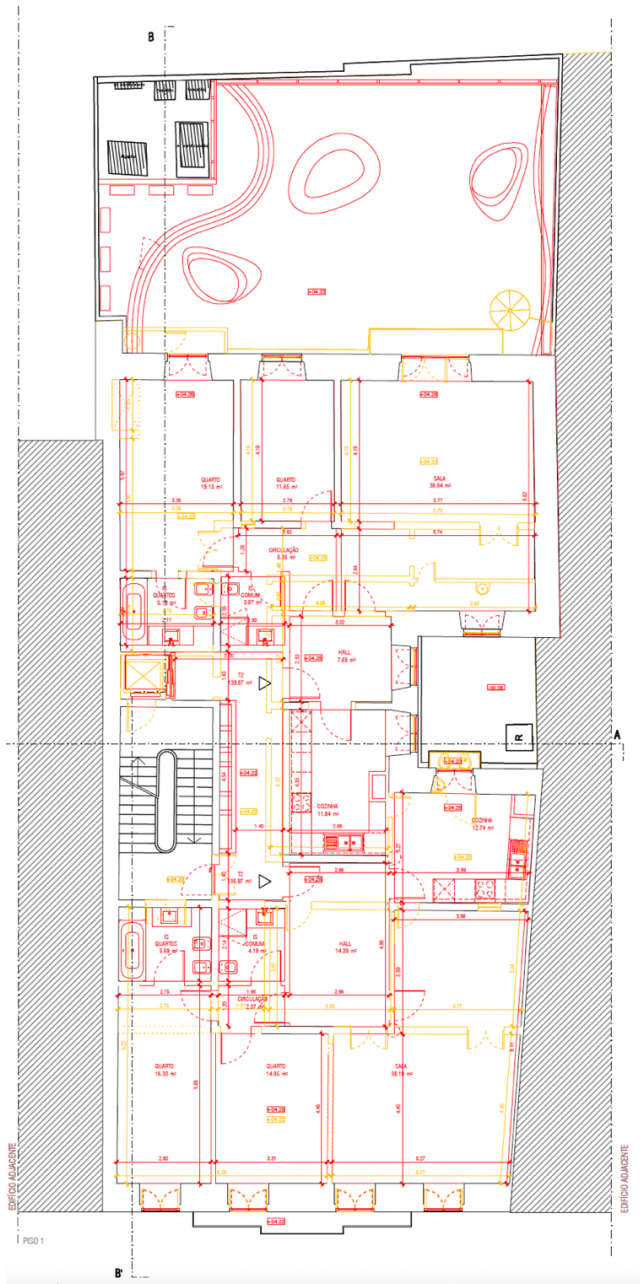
Edifício na Praça dos Restauradores, 53-56; planta do 1.º andar mostrando as alterações interiores, com preservação dos alinhamentos estruturais paralelos à fachada (2014).
